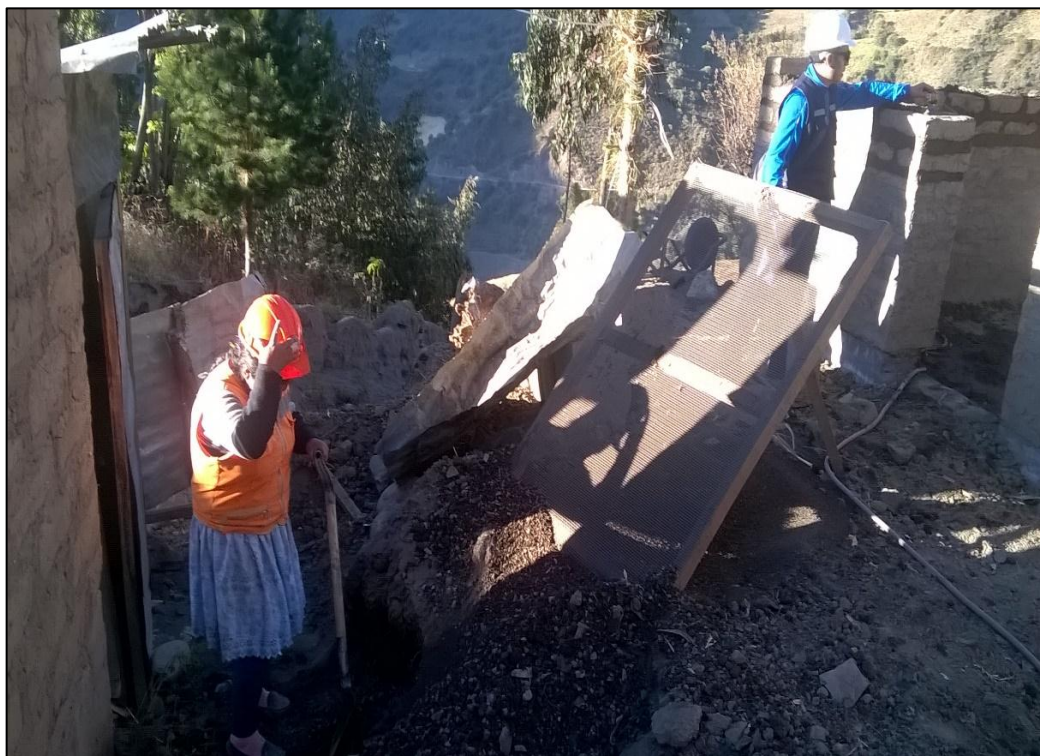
Zarandeo de tierra para barro para asentar muro de adobe
